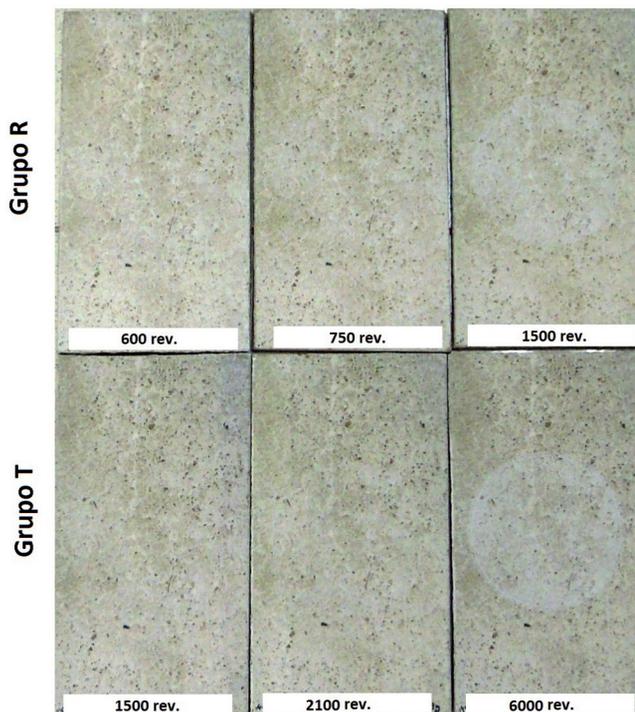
Estado de las piezas tras el ensayo de abrasión.
